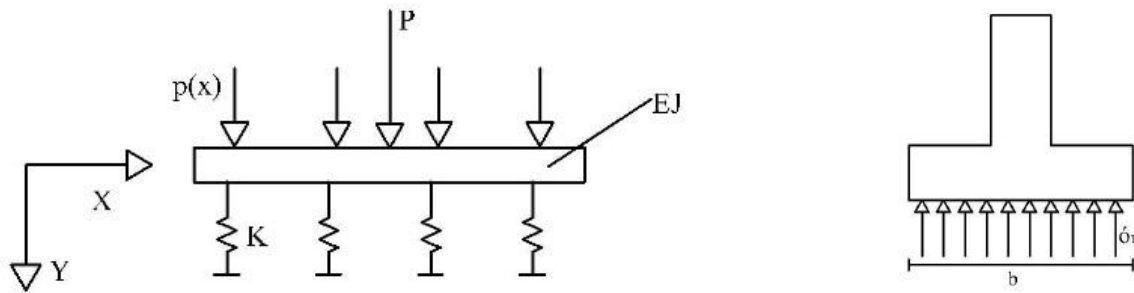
Trave appoggiata al suolo alla Winkler
